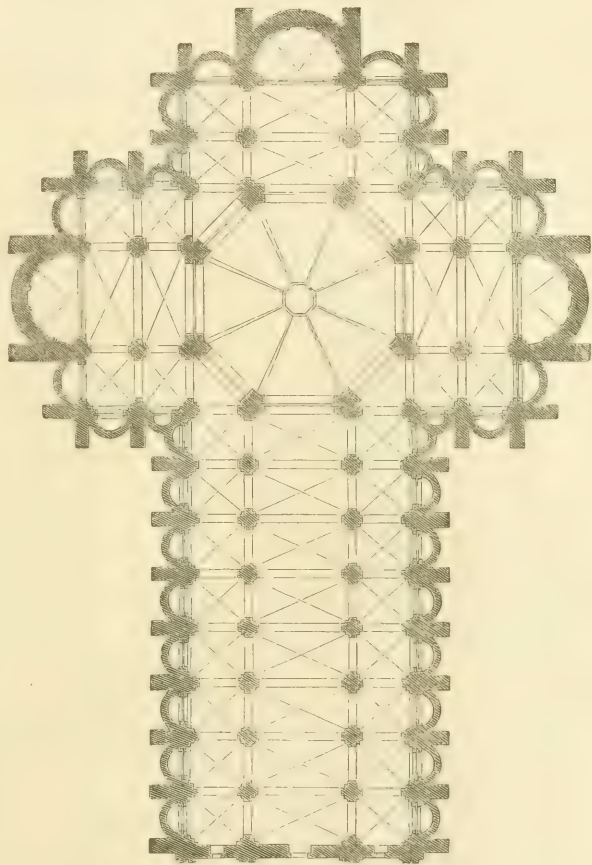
Dom zu Pavia. Grundriss.
